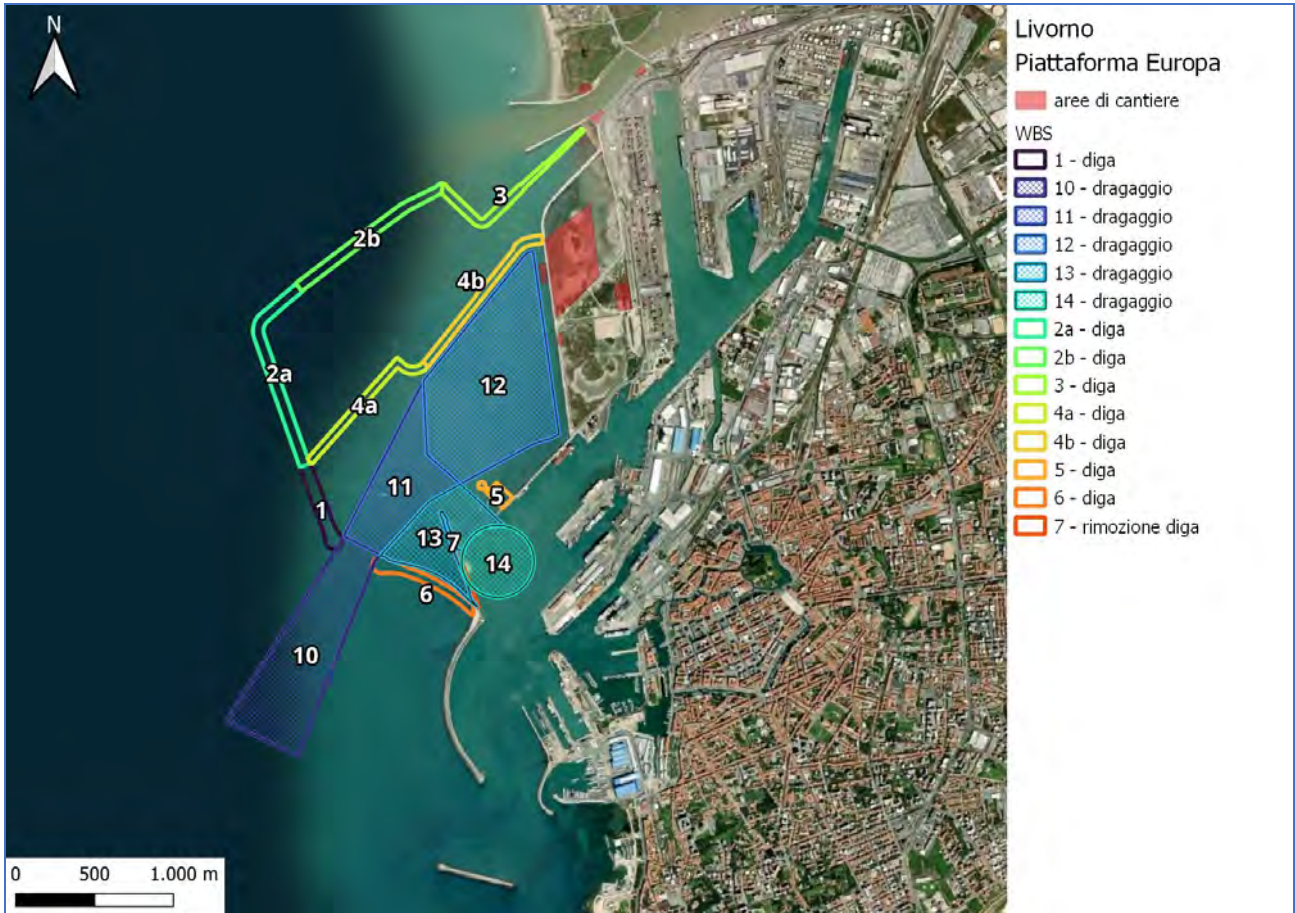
Individuazione delle WBS e delle aree di cantiere previste
